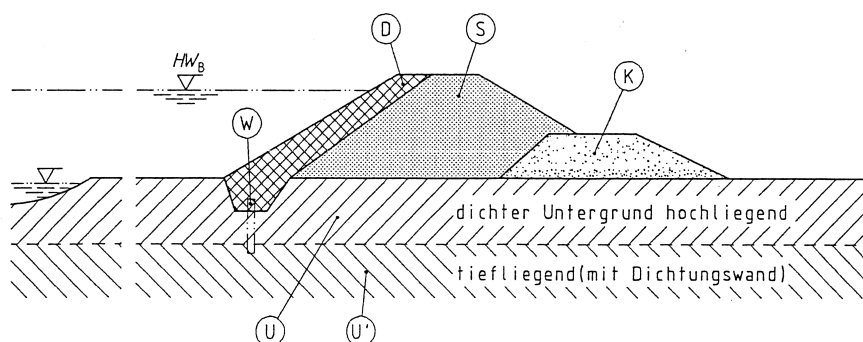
Drei-Zonen-Deich (DIN 19712, 1997) S – Stützkörper; D – Dichtungsschicht; U – Untergrund (möglichst dicht); U' - Untergrund (tief liegend) ggf. mit wandartiger Dichtung (W); K – Dränkörper (durchlässig)
